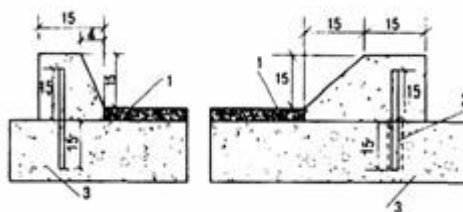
Монолитный бордюр; 1 - новое покрытие; 2 – стержень арматуры; 3 - существующее бетонное покрытие
